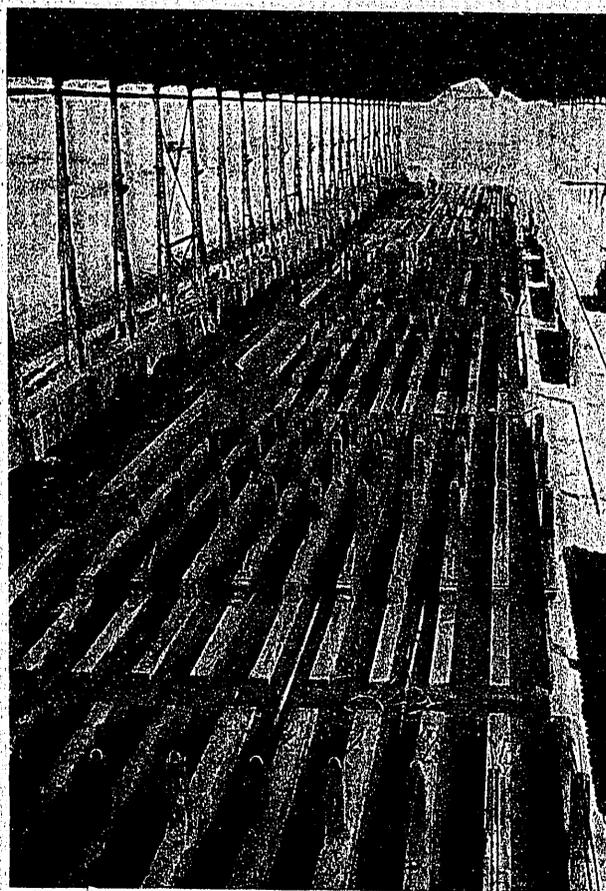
Taller de prefabricación de vigas. Nave de laminación de ENSIDESA (Avilés).
